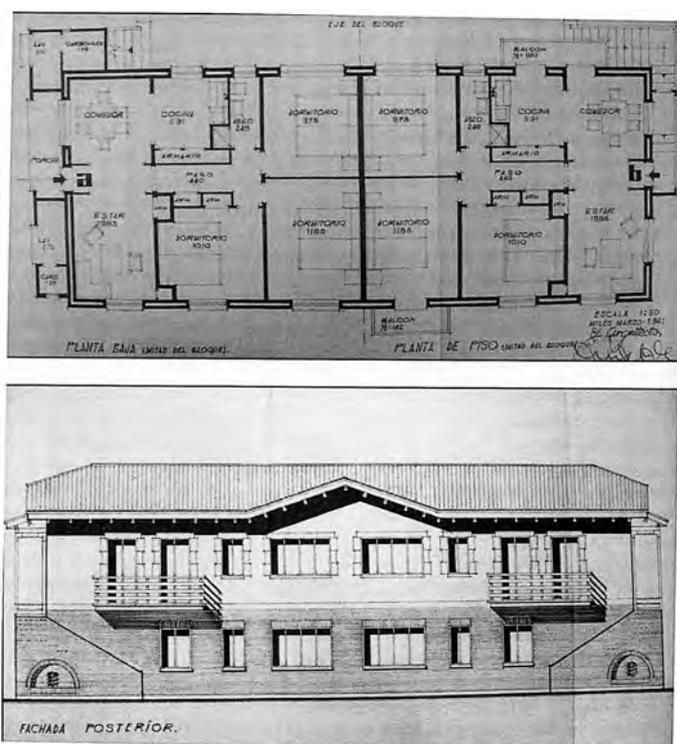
Planta y fachada posterior de chalet de cuatro viviendas. Jardín de Cantos, 1961. Fuente: *Cristalería Española, S.A. Viviendas e instalaciones. Caja 1087*. Archivo Municipal de Avilés.
